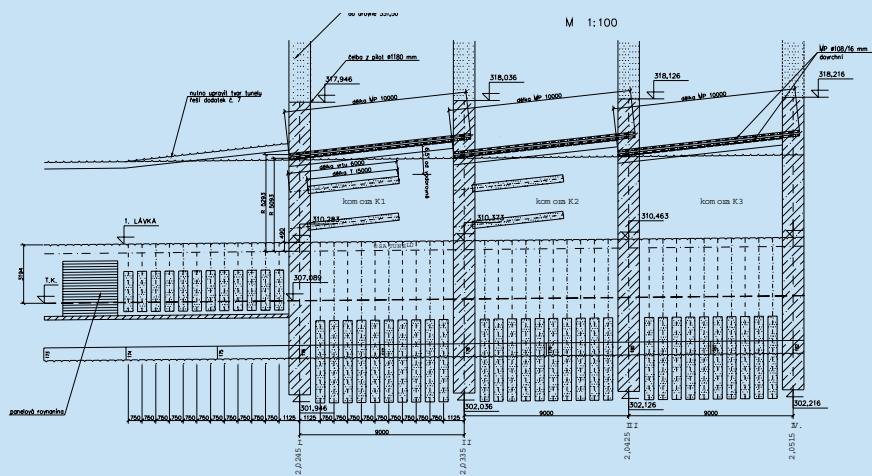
Geotechnický profil zhmáhaným úsekem (podle RNDr. J. Altmana, 2006)
